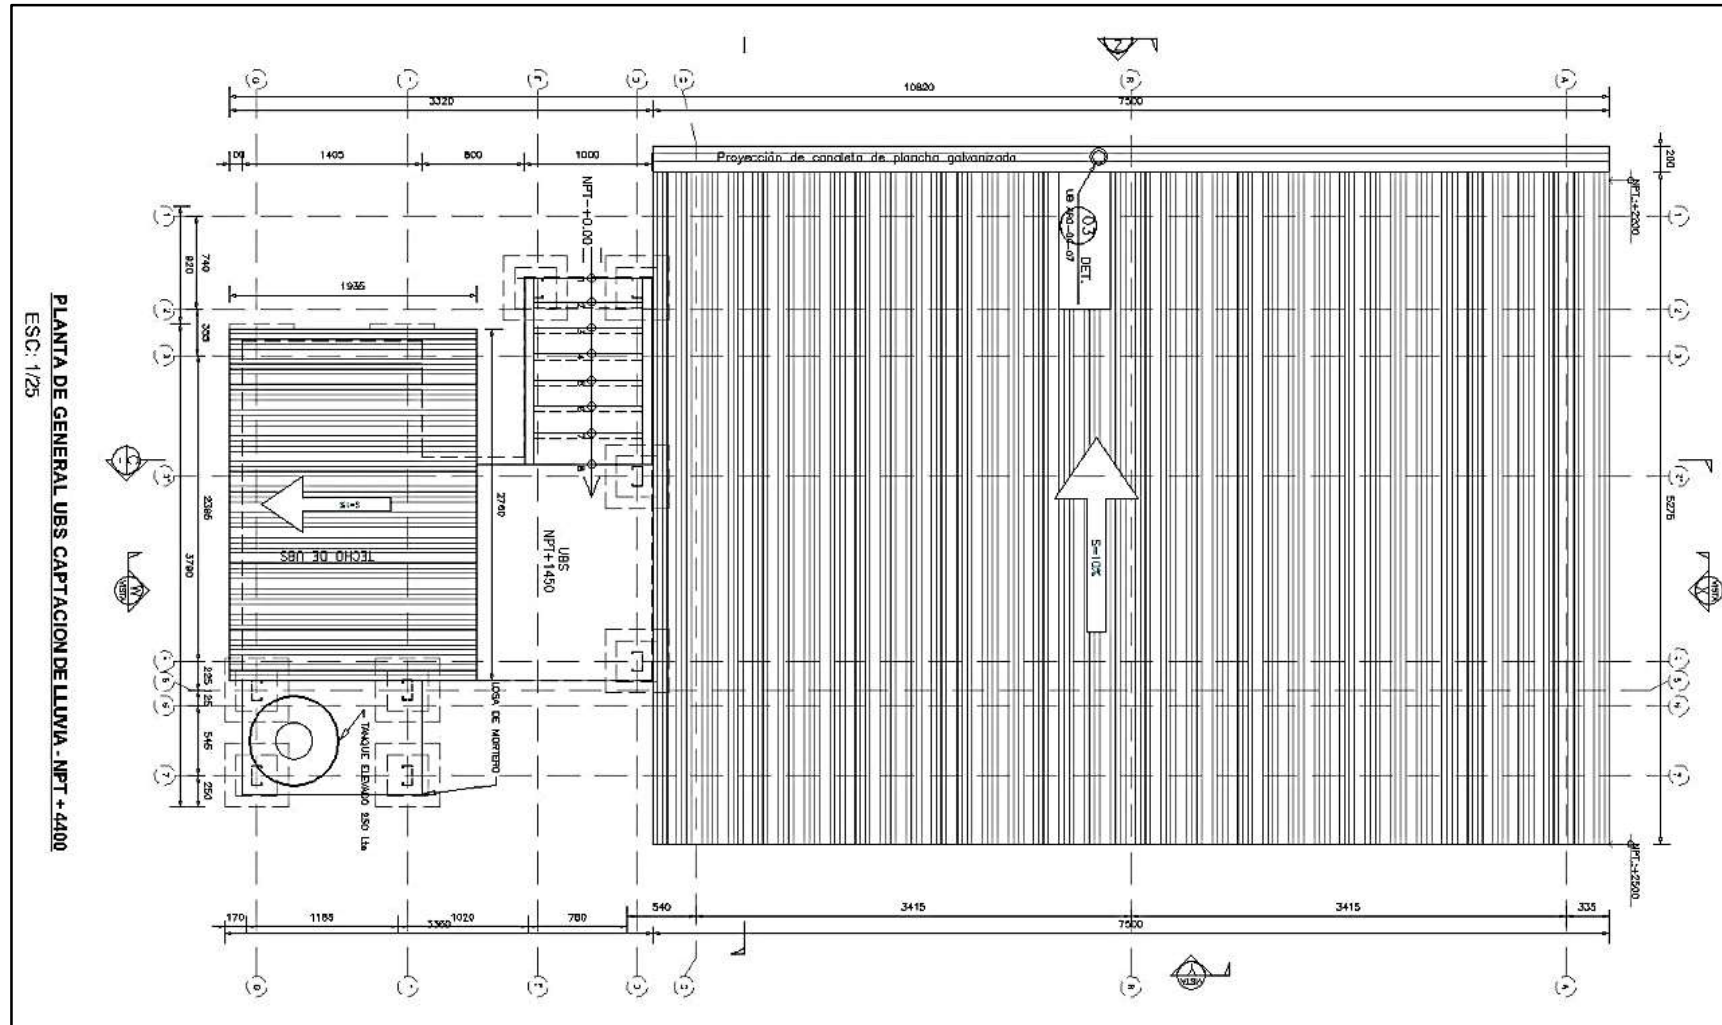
plano de planta del módulo domiciliario UBS mediante el sistema Steel Framing
